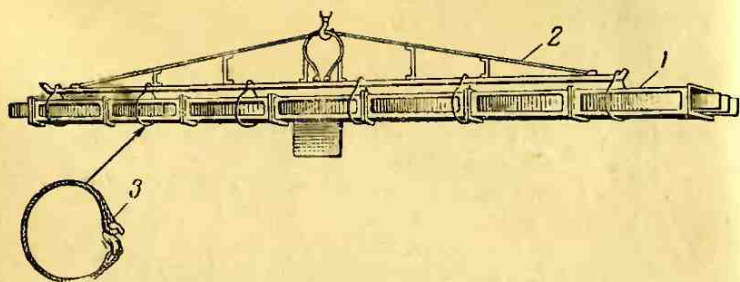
Сварная траверса для подъема блоков магистральных шинпроводов.
